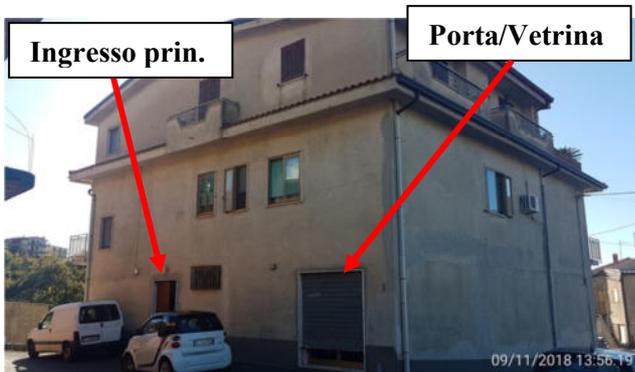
3 / 4 – Facciata lato Nord-Est / Facciata lato Ovest
